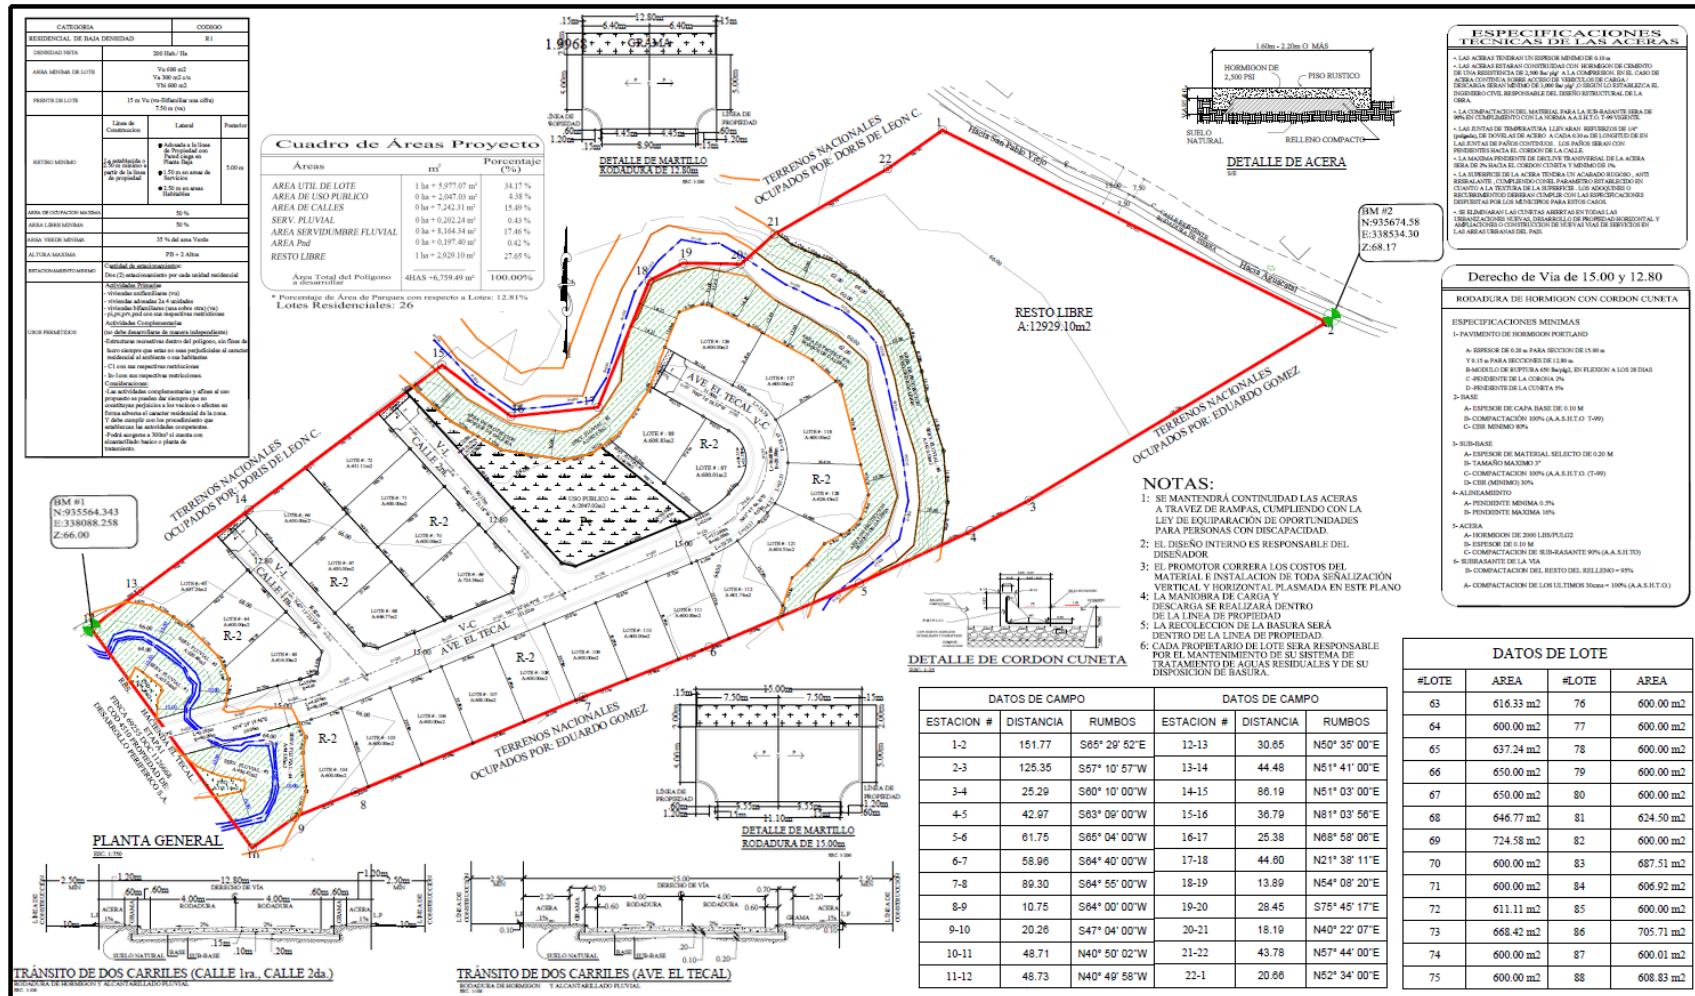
Plano de planta de Anteproyecto del proyecto Residencial “Hacienda El Tecal 2da. Etapa”, *Fuente: Plano suministrado por el promotor
